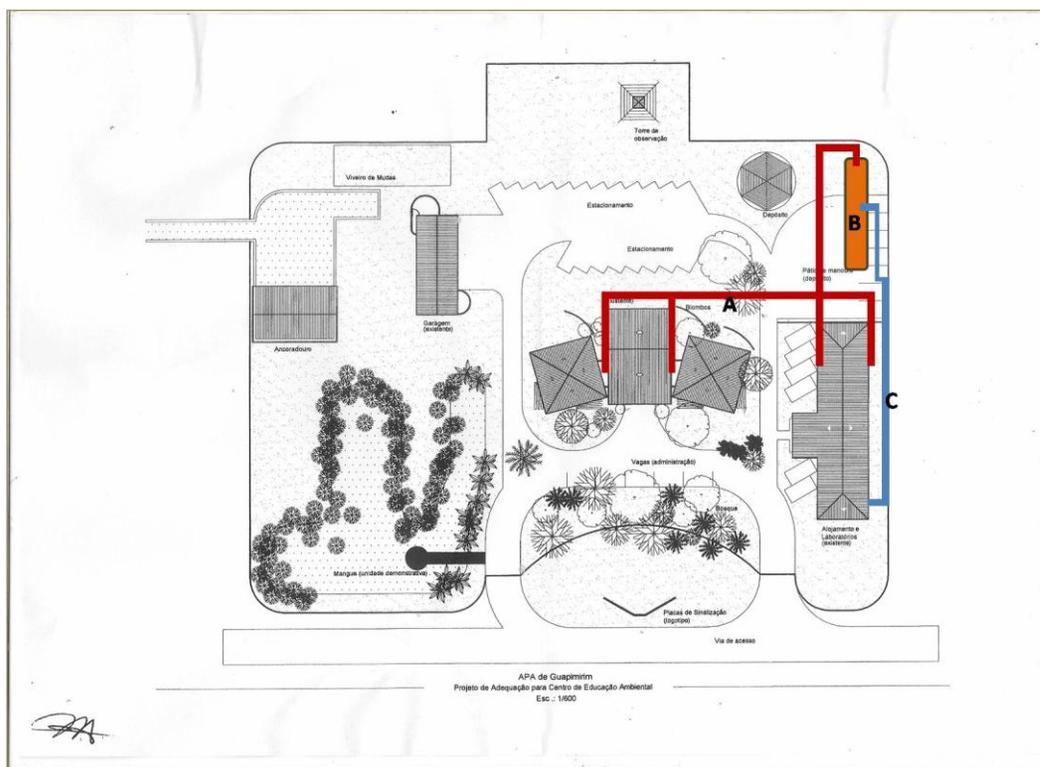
Planta da sede mostrando local indicado para instalação do biodigestor (B, em laranja), as tubulações (enterradas) para efluentes sanitários (A, em vermelho) dos sanitários até o biodigestor e a tubulação para o biogás (C, em azul) do biodigestor até a cozinha
